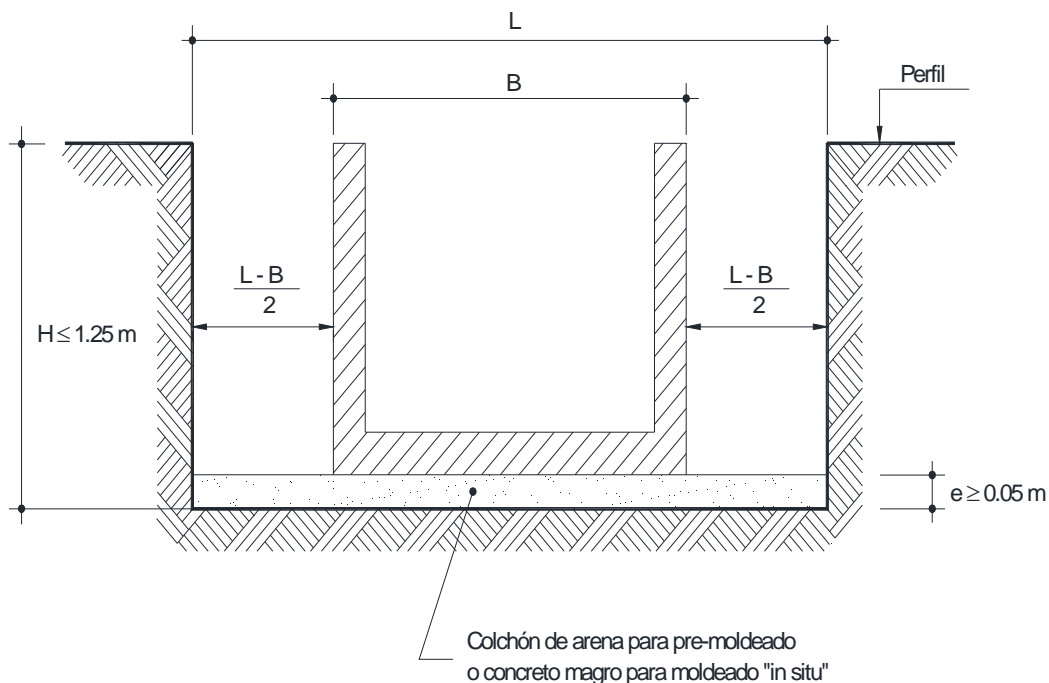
Cajas de Excavación para La Instalación del Drenaje a Una Profundidad de Hasta 1,25 m
